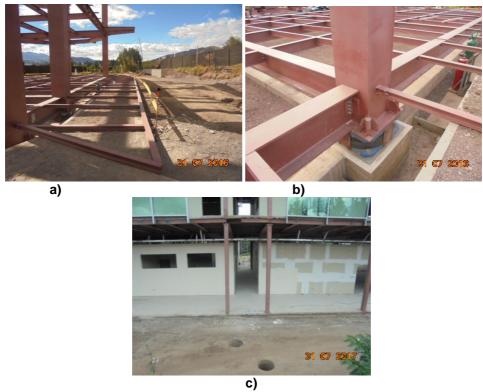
Construcción de Veredas en Bloque Arquitectónico 8; a) Vista de aisladores, zanja perimetral y vigas de acero que formarán parte de la vereda; b) Aislador todavía con las placas verticales que deben ser removidas y vigas de vereda; c) Piso fundido de las veredas.
